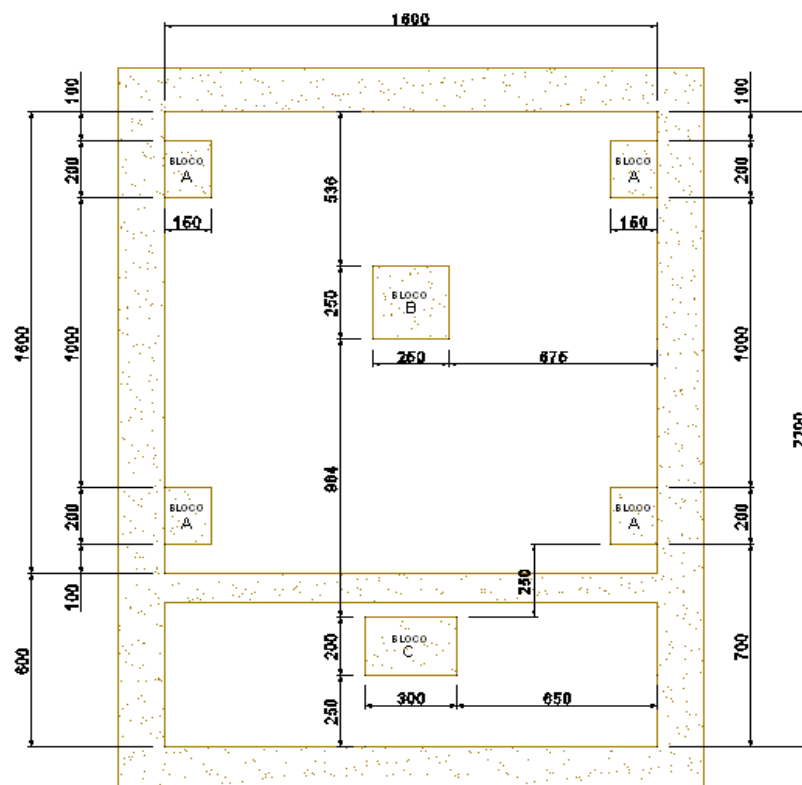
Planta-baixa com a disposição dos blocos de concreto-armado. Cotas em milímetros. UFLA, Lavras-MG. 2010
